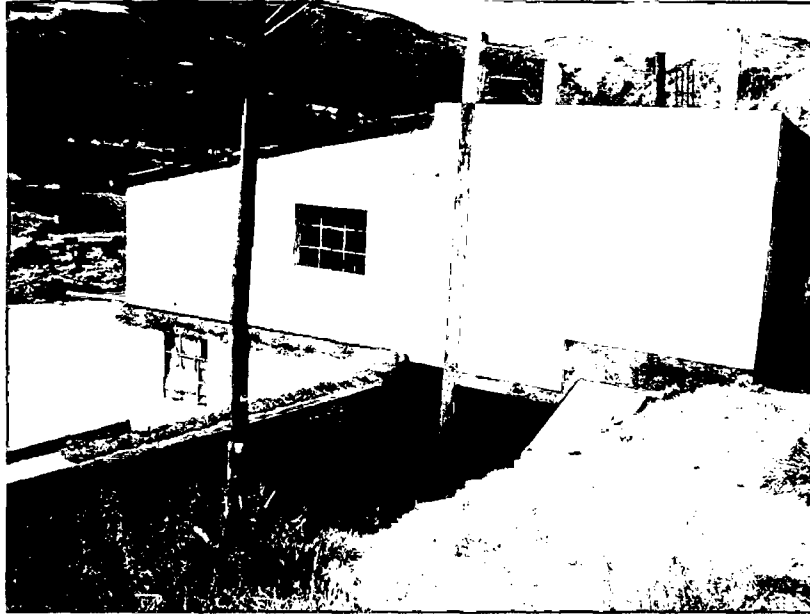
Vista exterior de la Estación de Bombeo Juntaysama
